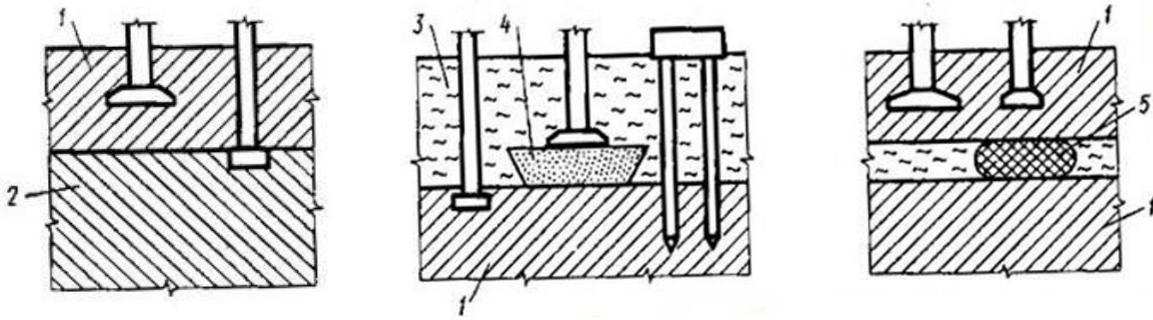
Схеми нашарувань ґрунтів з варіантами влаштування фундаментів: 1 – нормальний ґрунт; 2 – міцніший ґрунт; 3 – слабкий ґрунт; 4 – піщана подушка; 5 – зона закріплення ґрунту
